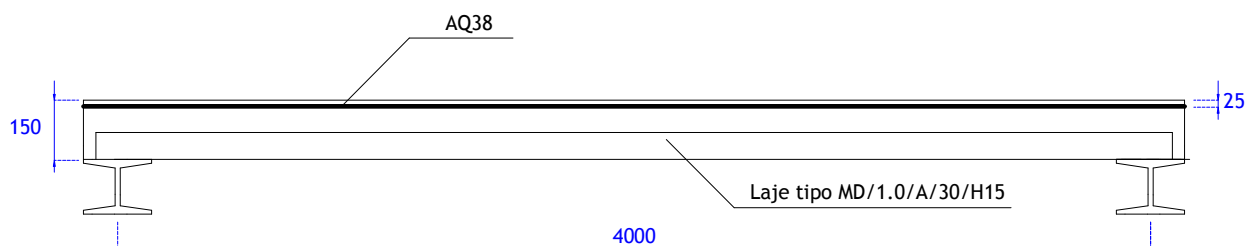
Corte longitudinal da laje mista simplesmente apoiada [distâncias em mm].
